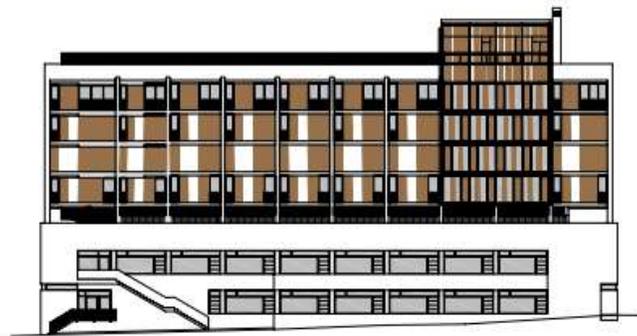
Fachada de Edificio Plaza América. Fuente: Sergio García y Pablo Martí.
